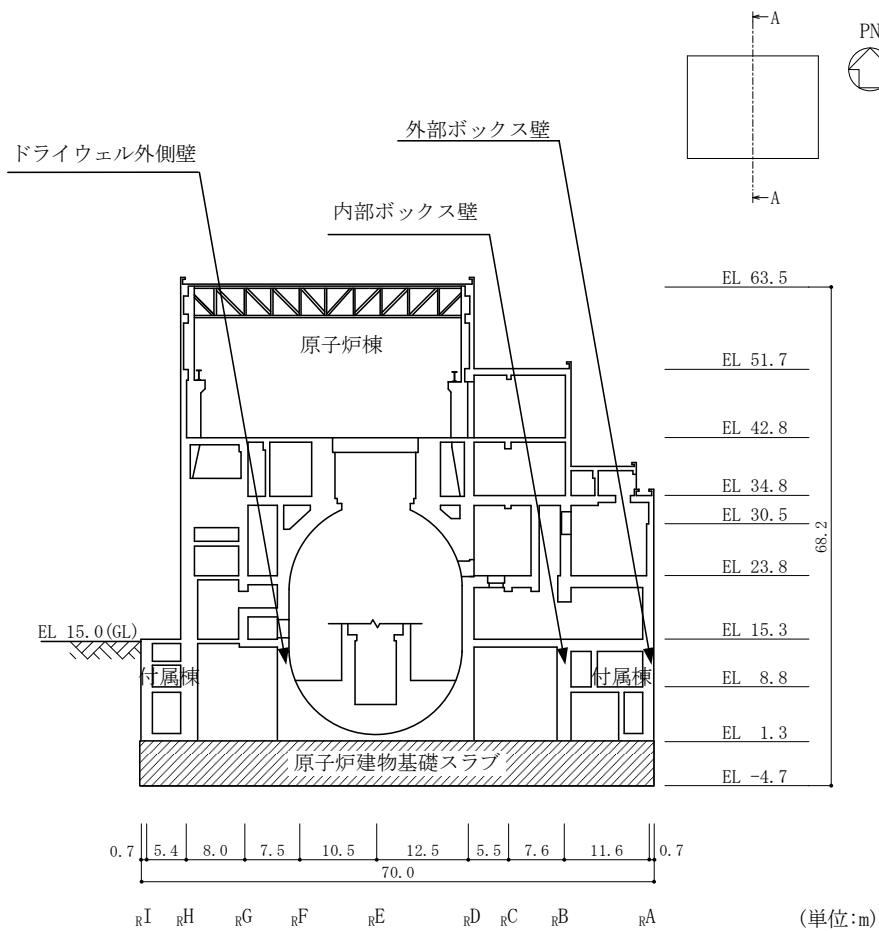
(1) 原子炉建物基礎スラブの概略断面図 (A-A断面, NS方向)
